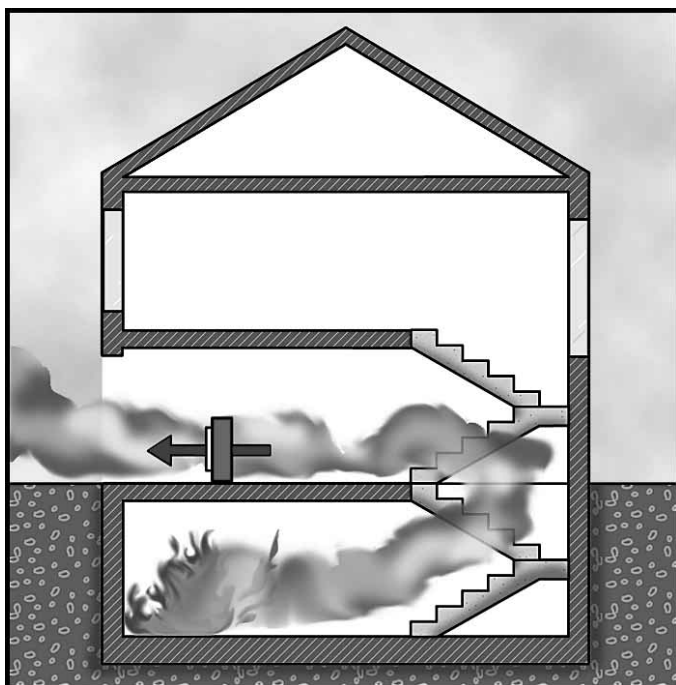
Se pueden usar las escaleras para ventilar un sótano.
